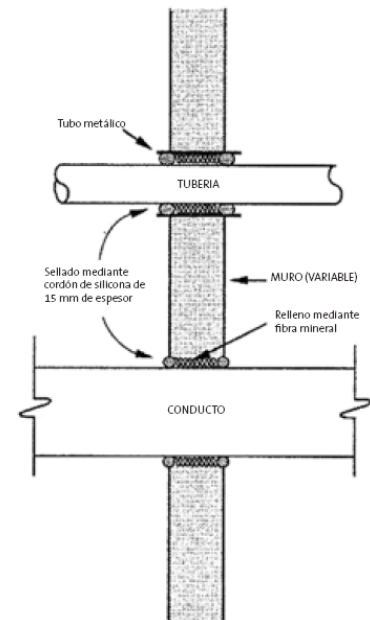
Tubos, cañerías y conductos aislados estructuralmente. (Fuente: Lara, 2008)
